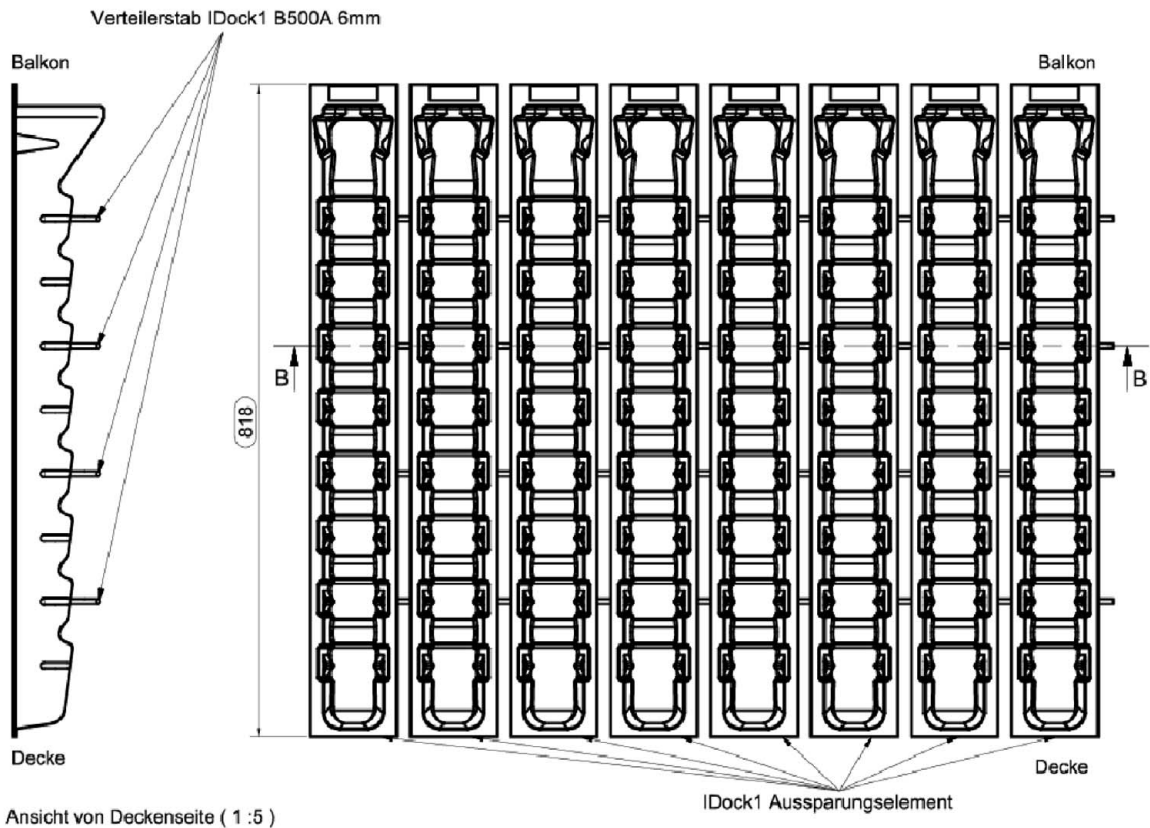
Beispiel Schöck Isokorb® XT Typ K-ID mit Betondrucklager bei indirekter Lagerung
